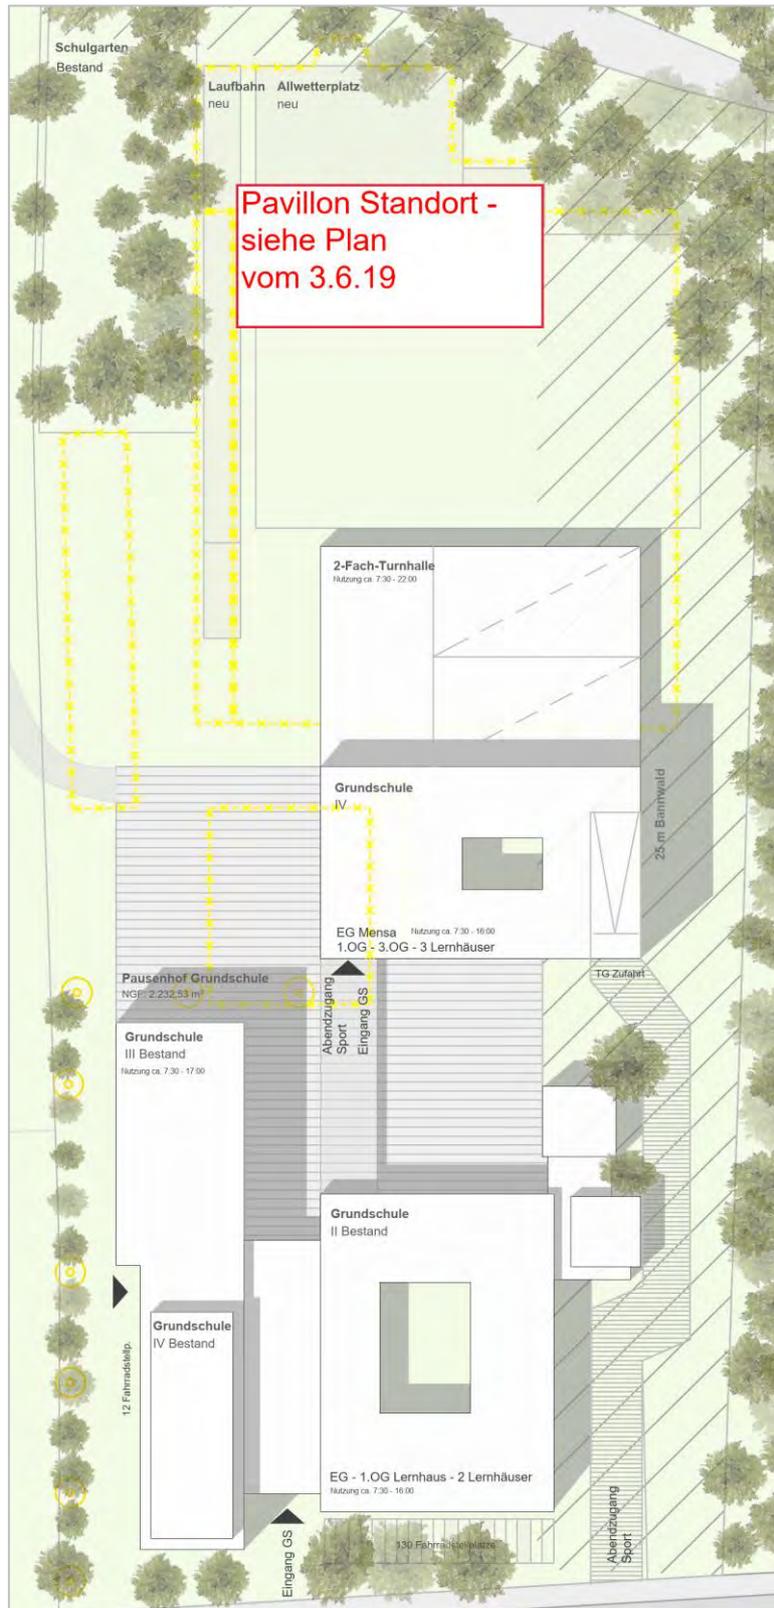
Lageplan Variante 2c [Quelle: LHM; Stand 19.11.2019]
